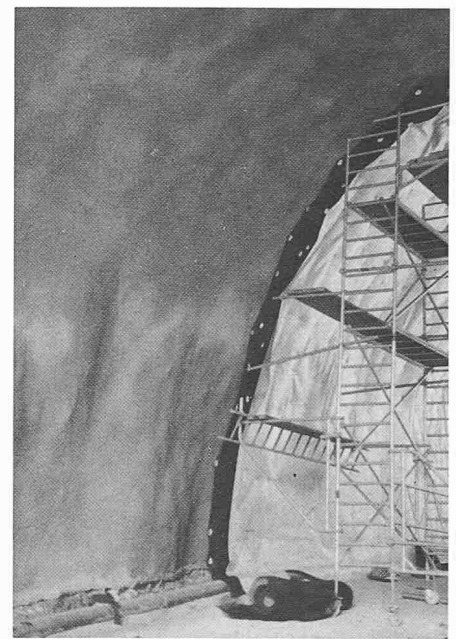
Mit Spritzbeton ausgekleideter Tunnel. Tragschicht der Abdichtung
